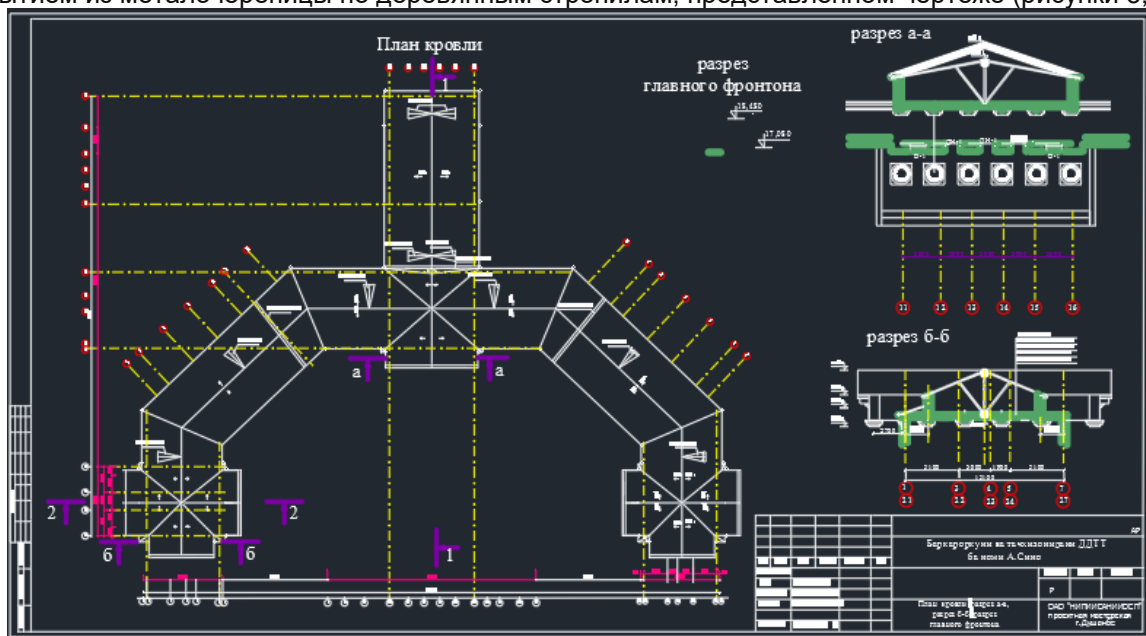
План кровли, фронтон -фрагменты разрезов, в программе AutoCad.
